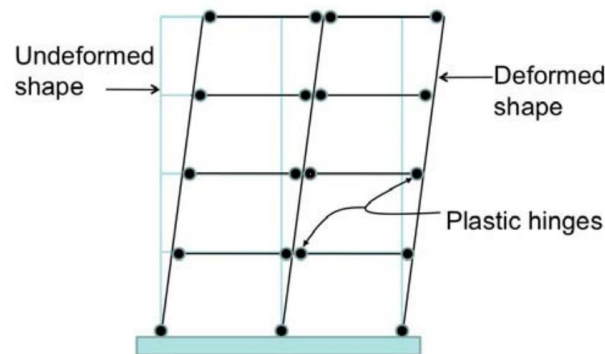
Mecanismo idealizado de SMFs bajo cargas laterales. (Hamburger, Krawinkler, Malley, & Adan, 2009)
